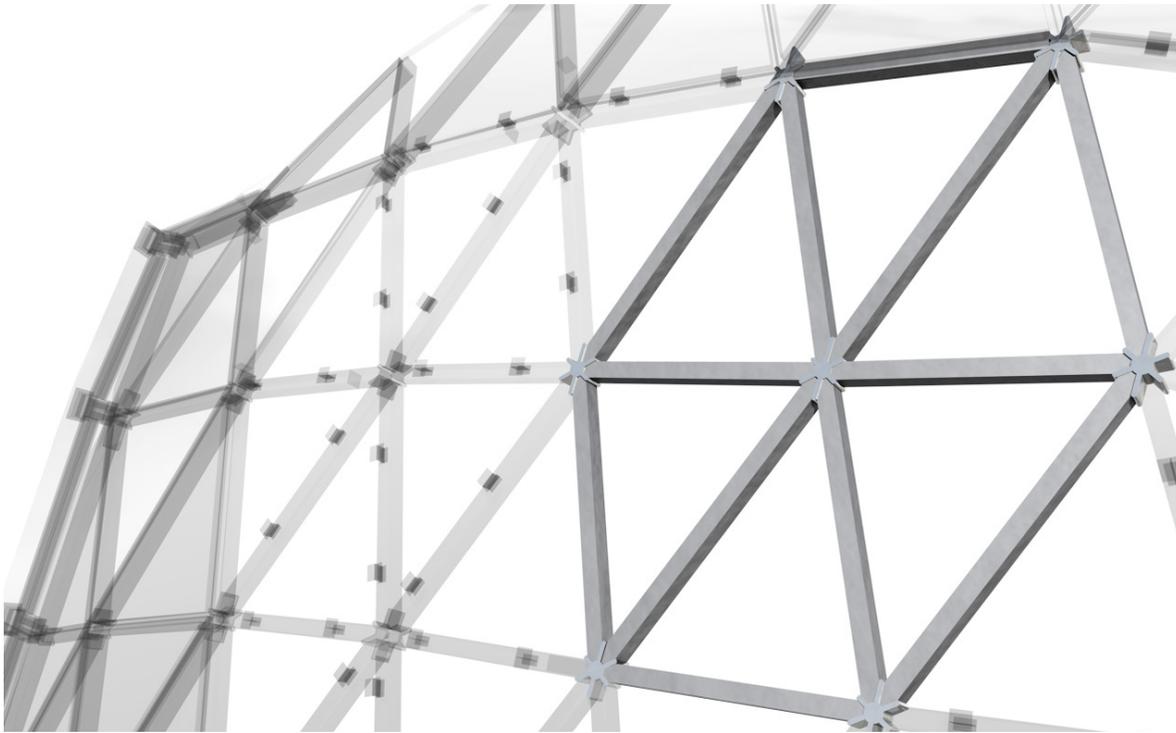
3D Darstellung Konstruktionsdetail
